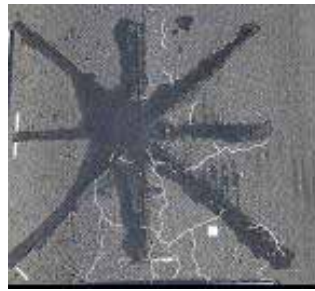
舗装のひび割れ (30 万輪走行後)
